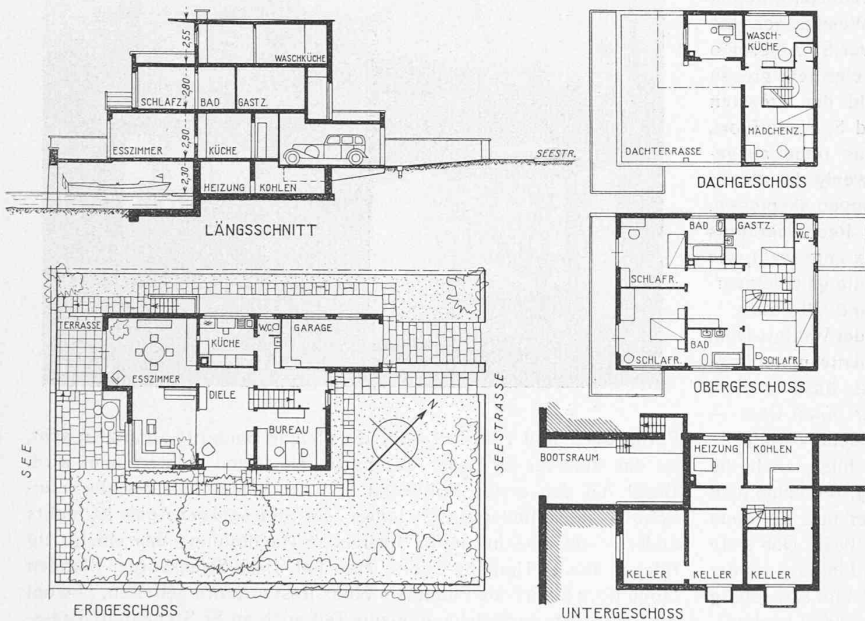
Lageplan, Grundrisse und Längsschnitt. — Masstab 1 : 400.
